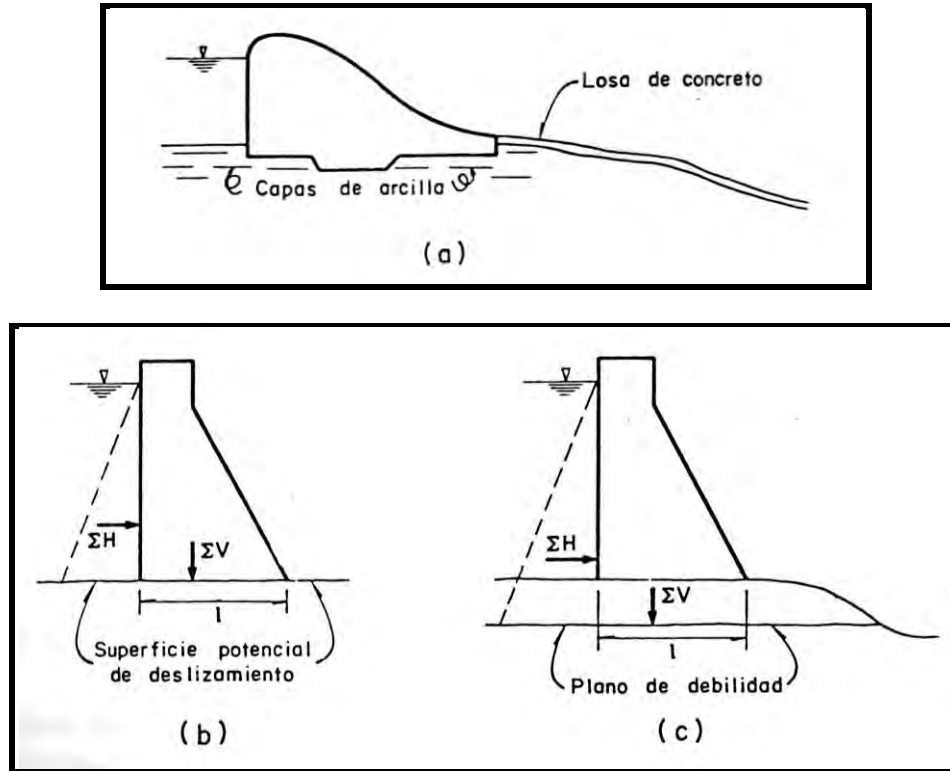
Deslizamiento sobre un plano de debilidad horizontal;
